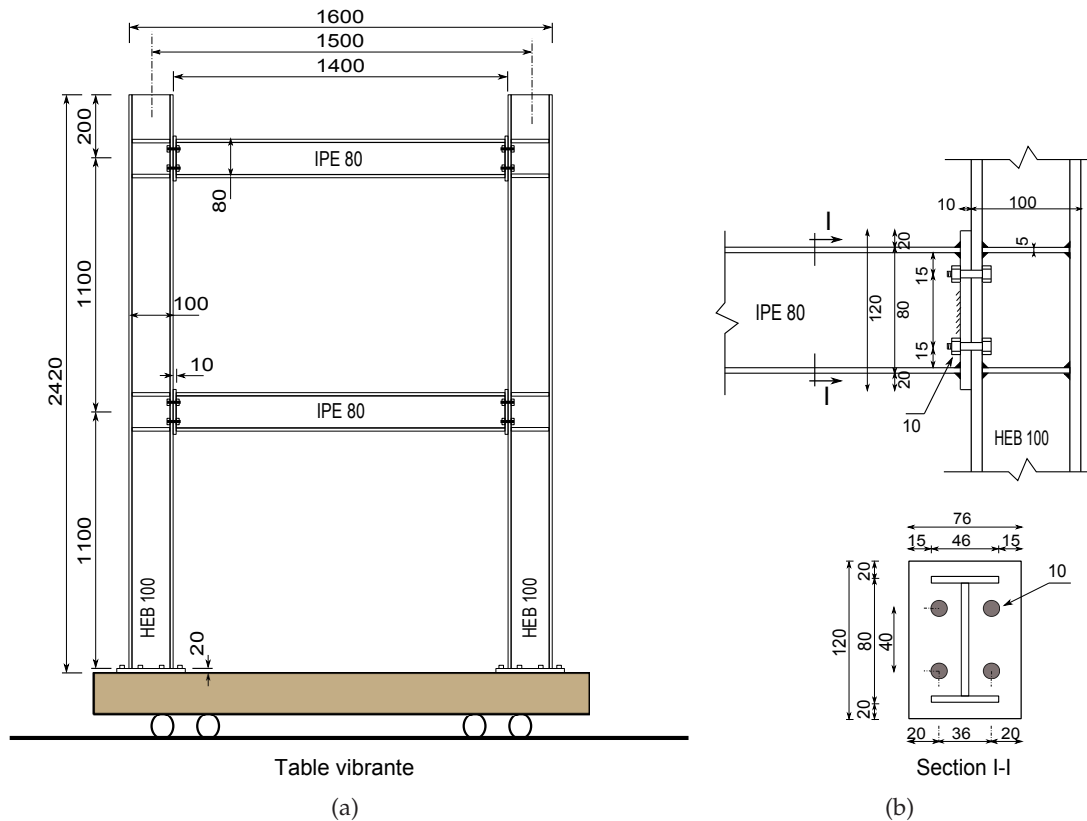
(a) Détail d'installation de l'essai et description de l'ossature en portique (en mm); (b) Détails de l'assemblage boulonné à plaque d'extrémité (en mm)
